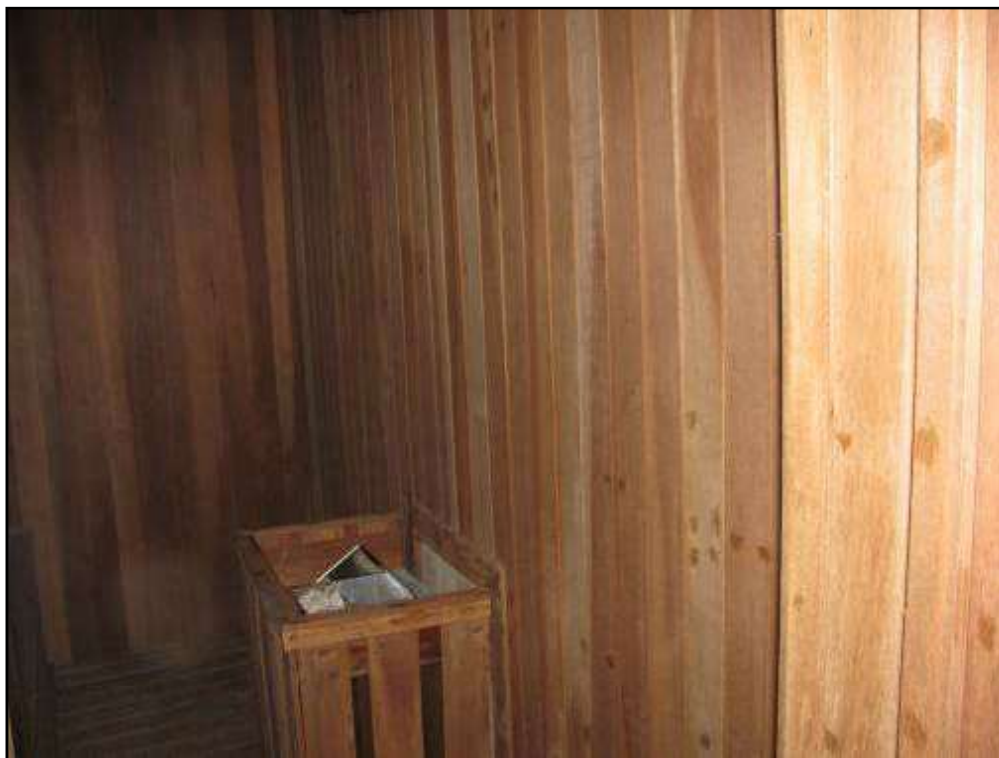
VISTA DA SAUNA SECA (TÉRREO).
